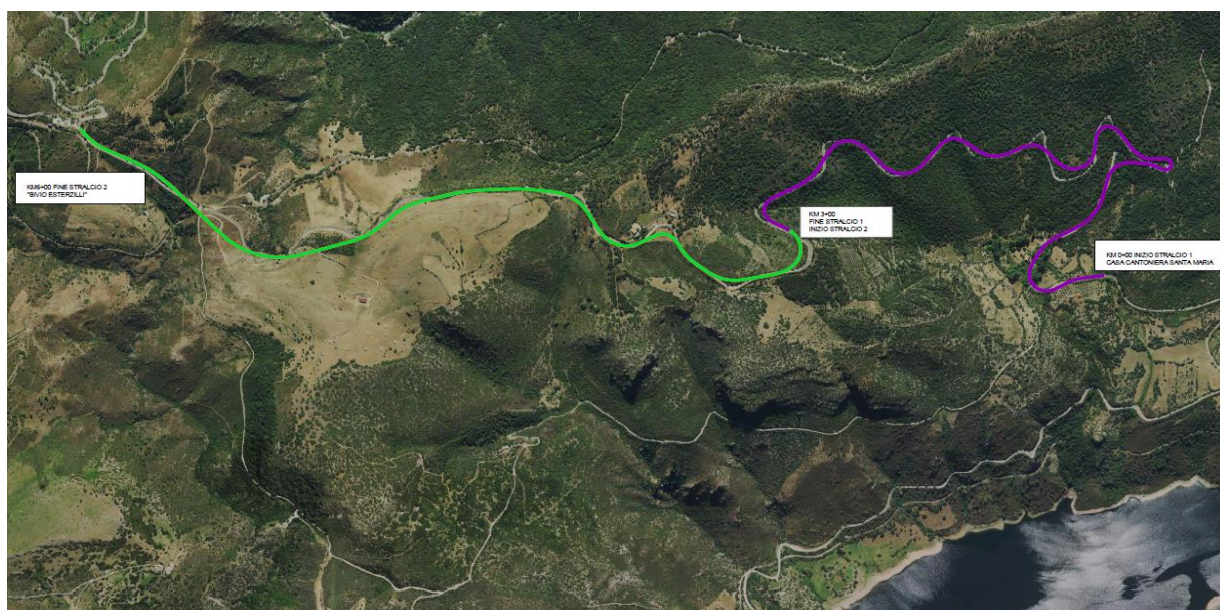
Ortofoto con indicazione dell'ipotesi di adeguamento in sede
